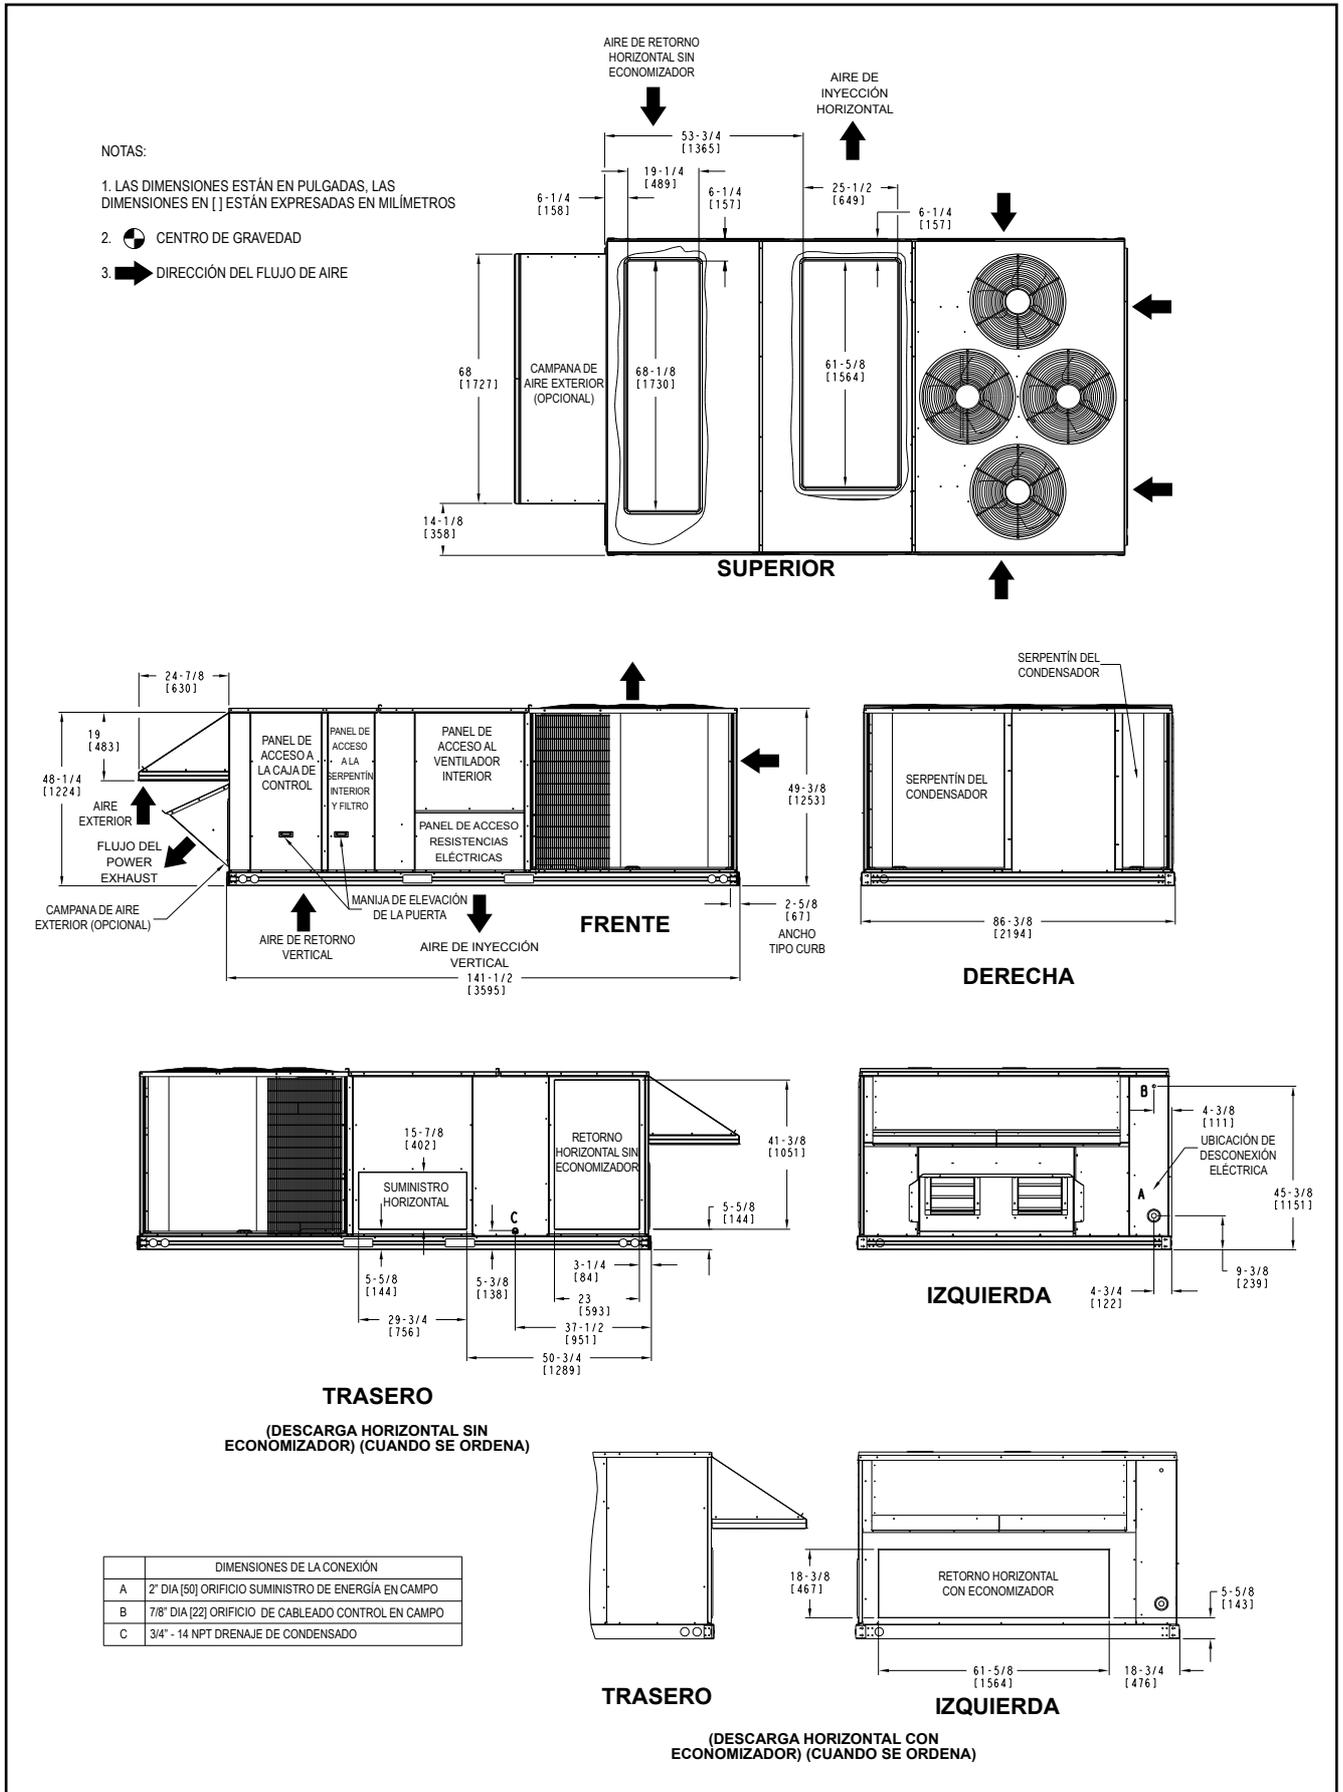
Dibujo dimensional de la unidad - 652EZ240
